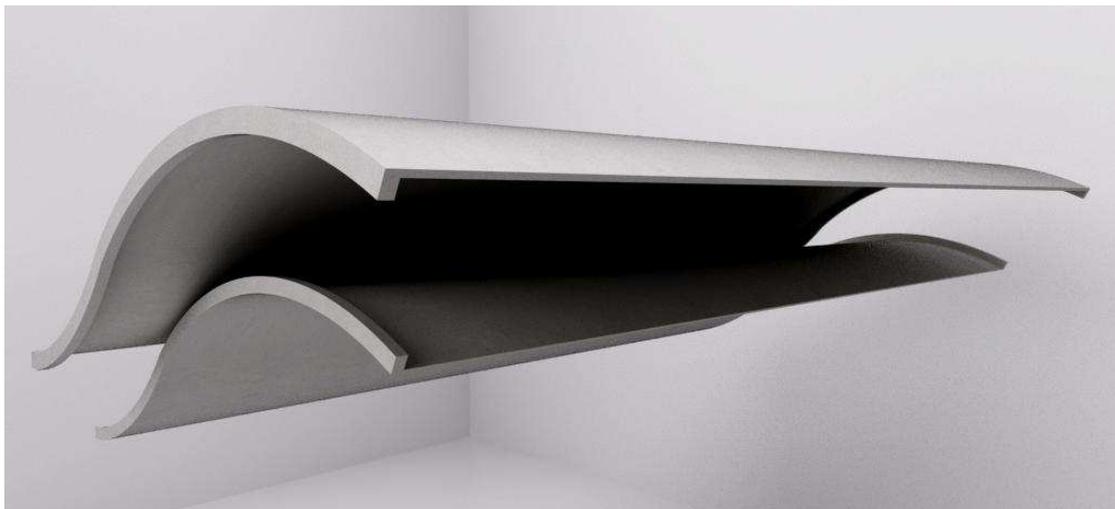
Sobreposição das peças que compõem a telha em argamassa armada.
